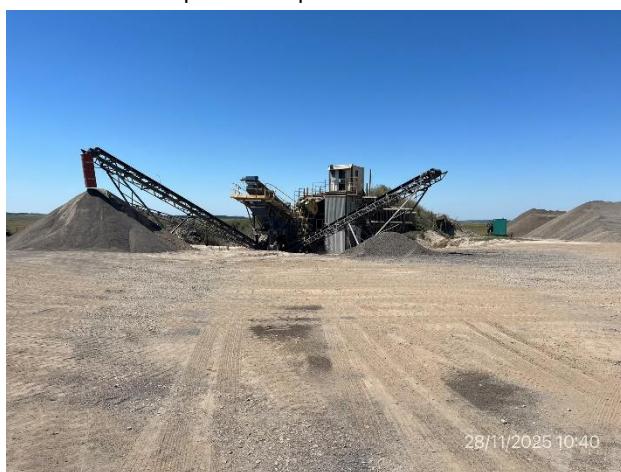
, P04. Planta de trituración sin actividad.
